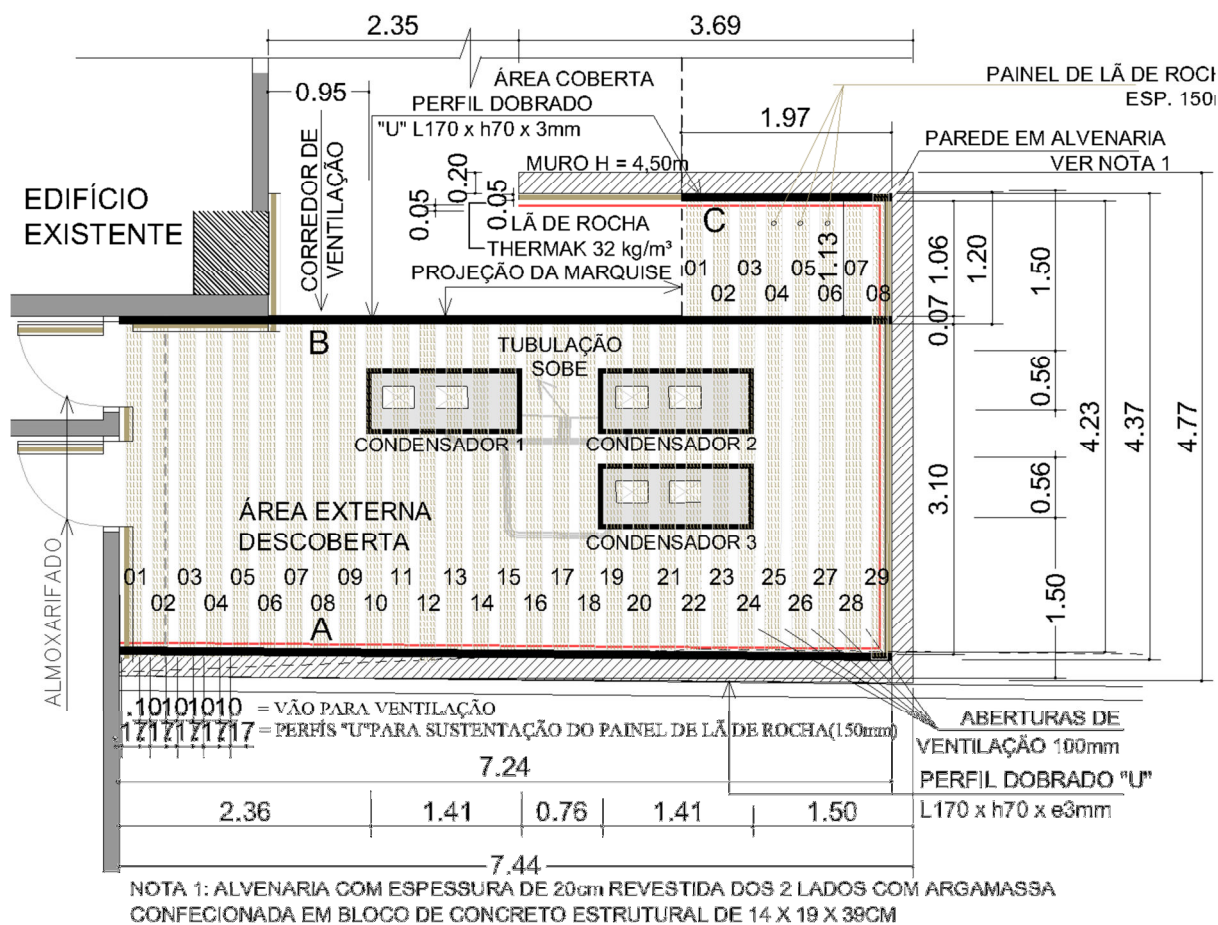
Planta dos perfis e painéis resistentes, sem escala
